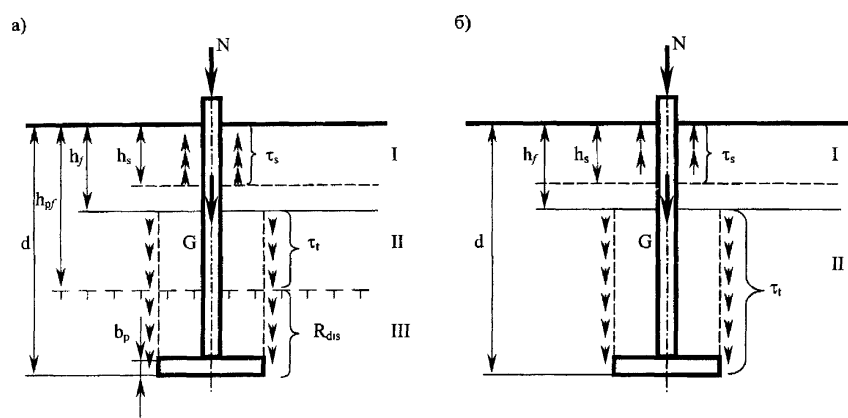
Расчетная схема на выпучивание фундамента с анкерной плитой:
